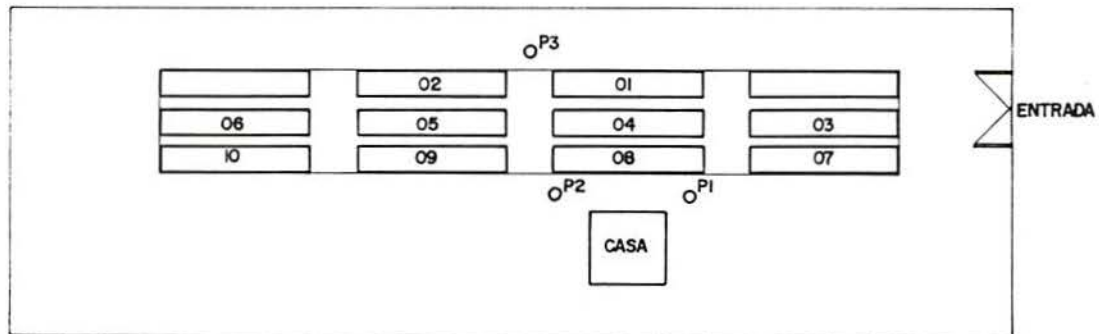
Posição esquemática dos piezômetros instalados junto às pistas
